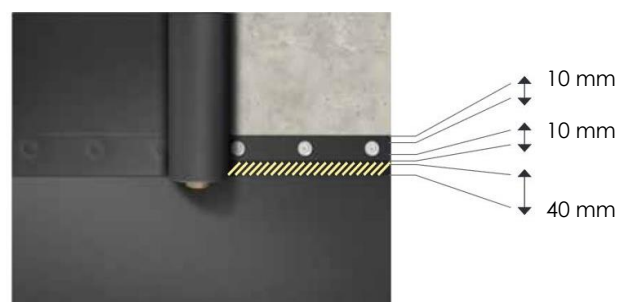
Joints longitudinaux sur membrane SUPERSEAL ST en cas de systèmes fixés mécaniquement
